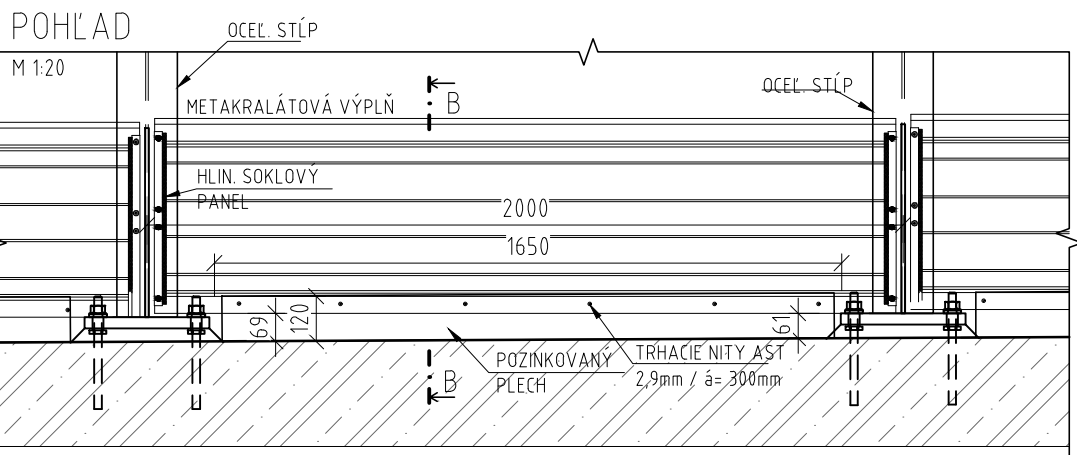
DETAIL ÚPRAVY POZDĽ. ŠKÁRY - KRYCÍ HLINÍKOVÝ PLECH
